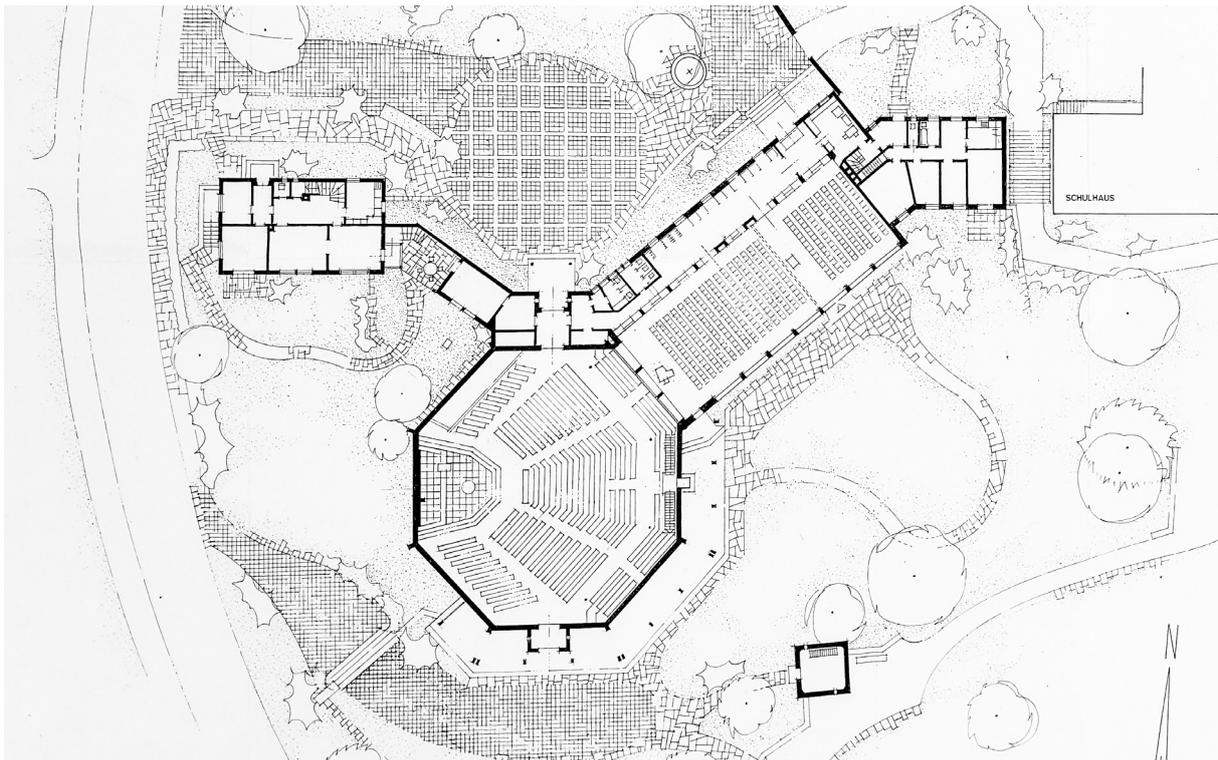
Plan des ausgeführten Projekt 1948 - Grundriss Kirche
